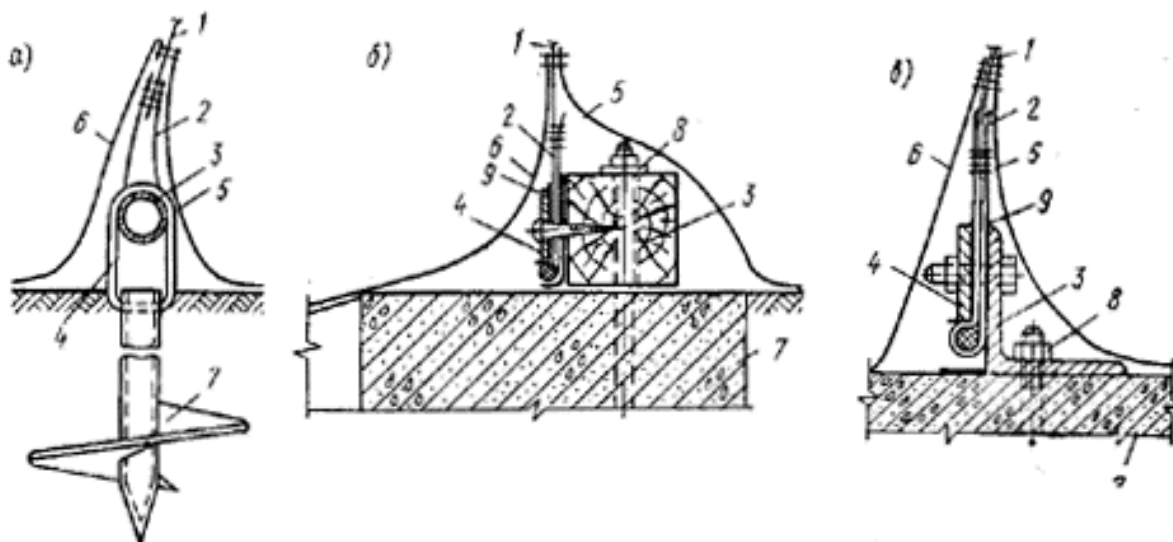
Крепление опорного контура оболочки: а — к винтовым сваям; б — к деревянному брусу; в — к металлическому уголку; 1 — оболочка; 2 — кромка оболочки; 3 — распределительный элемент; 4 — прижимная планка (серьга); 5 — внутренний фартук; 6 — наружный фартук; 7 — фундамент (винтовая свая); 8 — анкерный болт; 9 — резиновая прокладка
